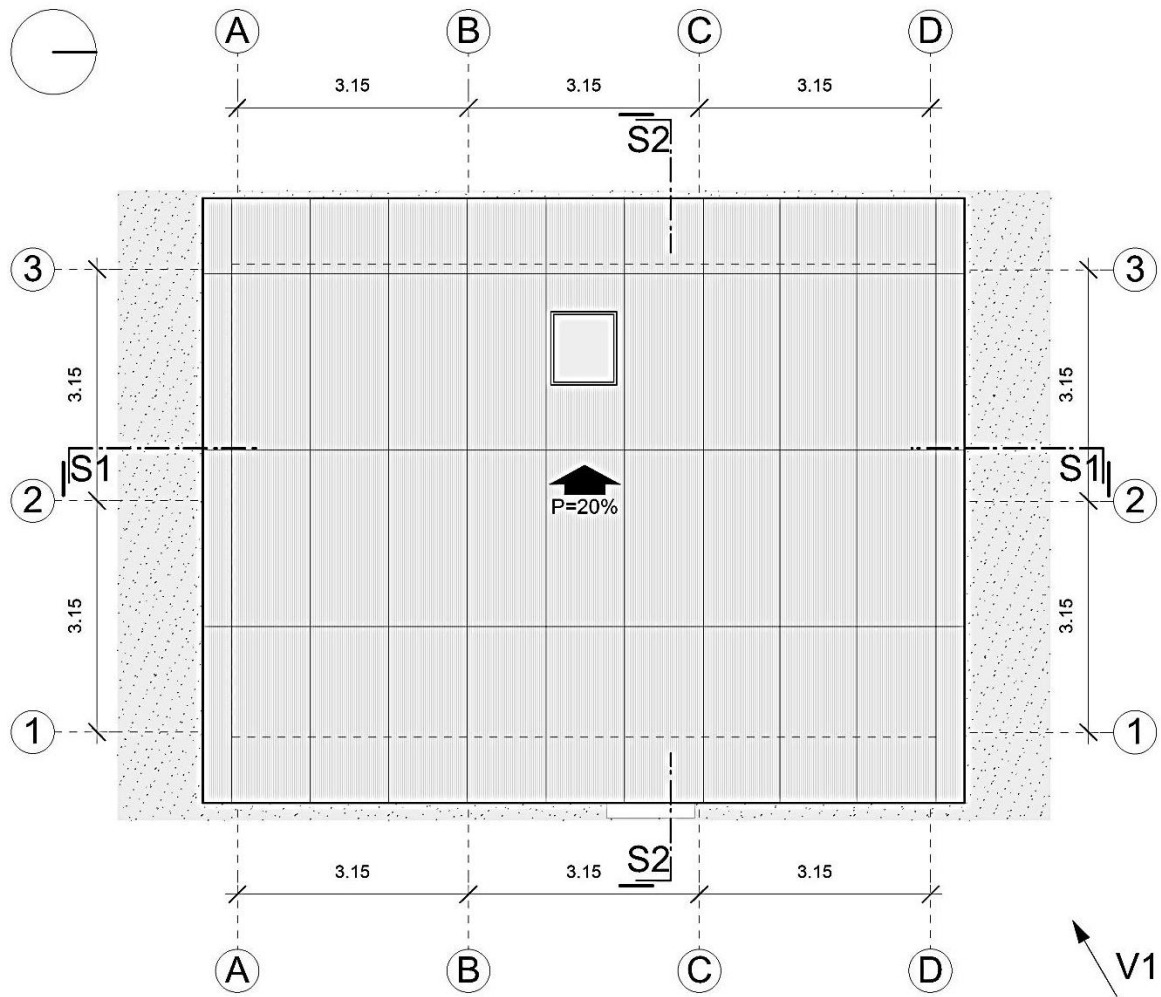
Planta de cubierta de la vivienda propuesta, escala 1=100. Autor: Paúl Rivas Rivas.
